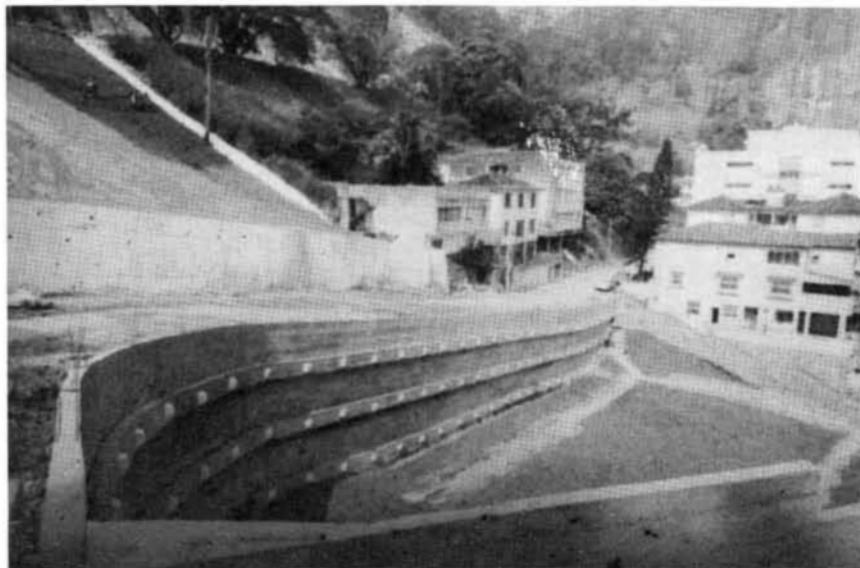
Estabilização de taludes com cortina ancorada com fundações sobre perfis na zona de escorregamento das Laranjeiras – DER GB e Instituto de Geotécnica
